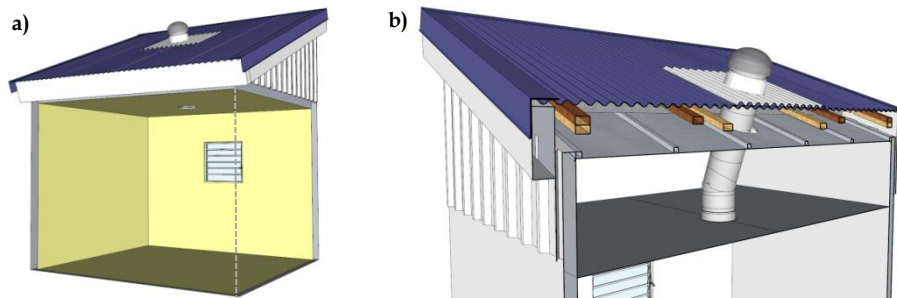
a) Zone d'étude b) Coupe schématique transversale de la zone « comble » équipée du conduit
